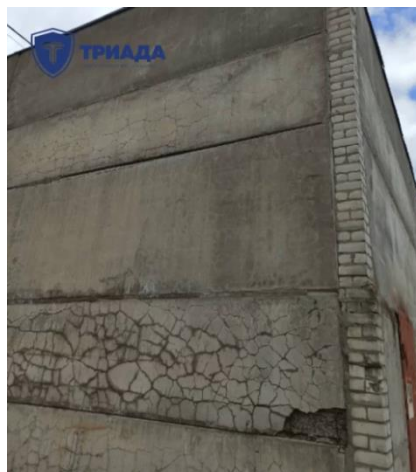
Разрушение железобетонных панелей с оголением и коррозией арматуры
